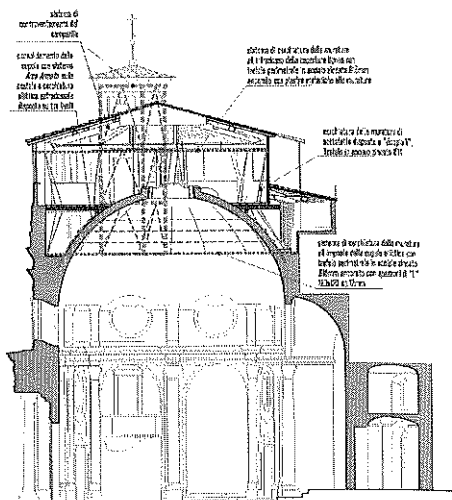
Sezione A-A della Chiesa di Santa Caterina a Lucca - Interventi di consolidamento
